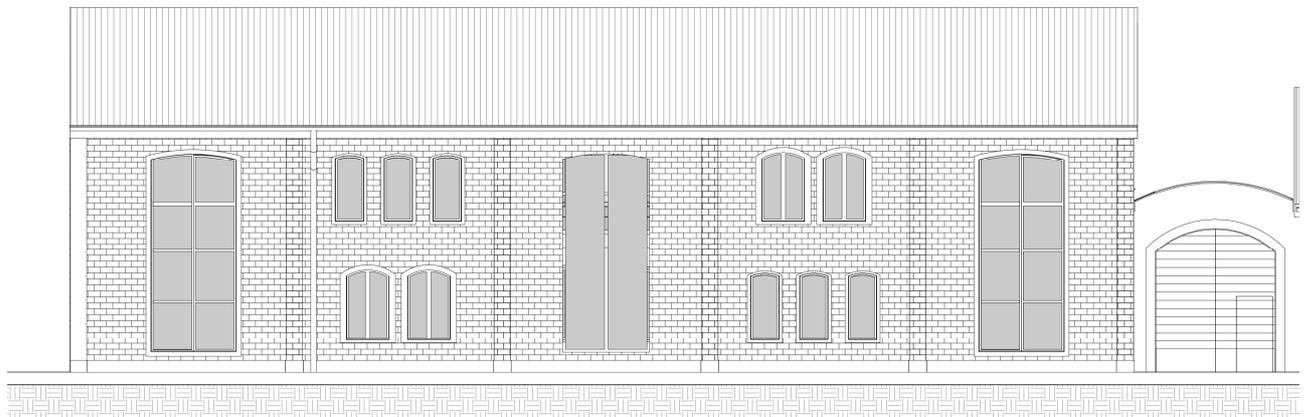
Prospetto Sud Atelier (Tav. n° 8 scala 1:100)
